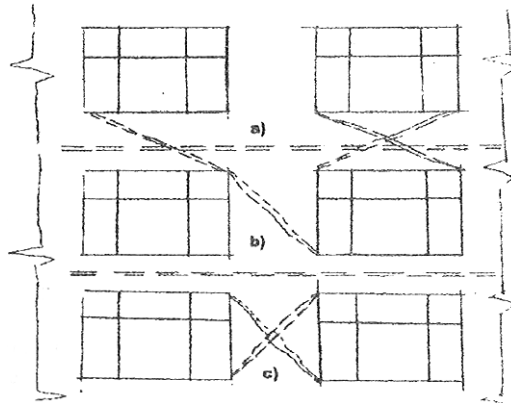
Fisurarea montanților și/sau a parapetilor
